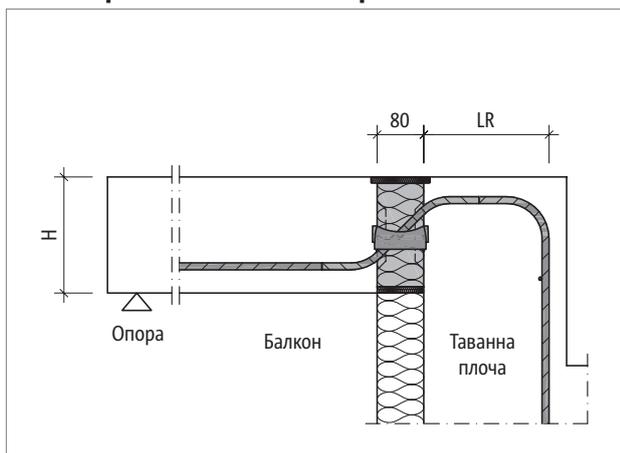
Schöck Isokorb® T тип QP-WU: Свързване със стена надолу с външна изолация
